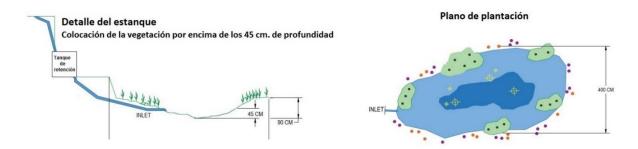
Detalle del modelo mBiGPond. Fuente: Proyecto básico y de ejecución EB1 Falcão
